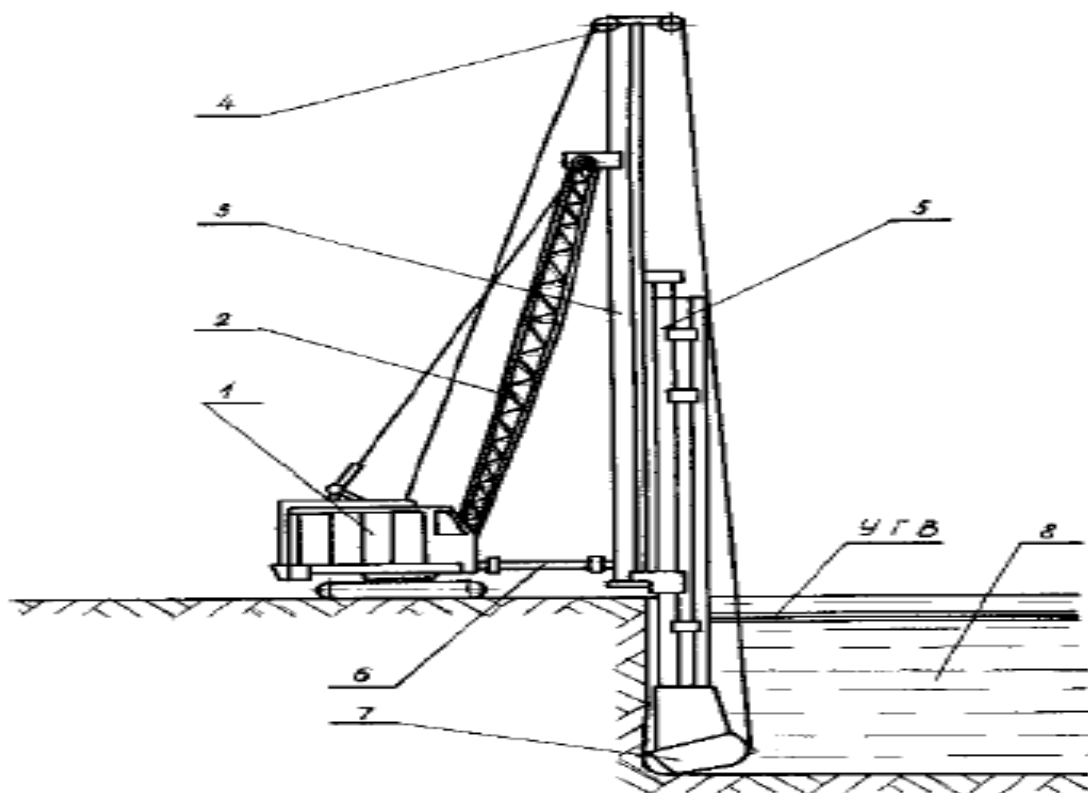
Штанговый экскаватор ЭК-600: 1 - базовая машина; 2 - стрела; 3 - копровая стойка; 4 - оголовок; 5 - рукоять; 6 - падающее устройство; 7 - ковш; 8 - разрабатываемая траншея
